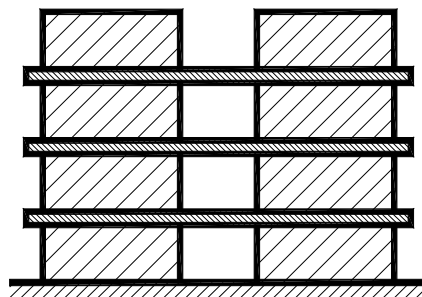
Сталежелезобетонные конструктивные системы. Тип 3 – сталежелезобетонные или бетонные стены, объединенные стальными или сталежелезобетонными связующими балками.
